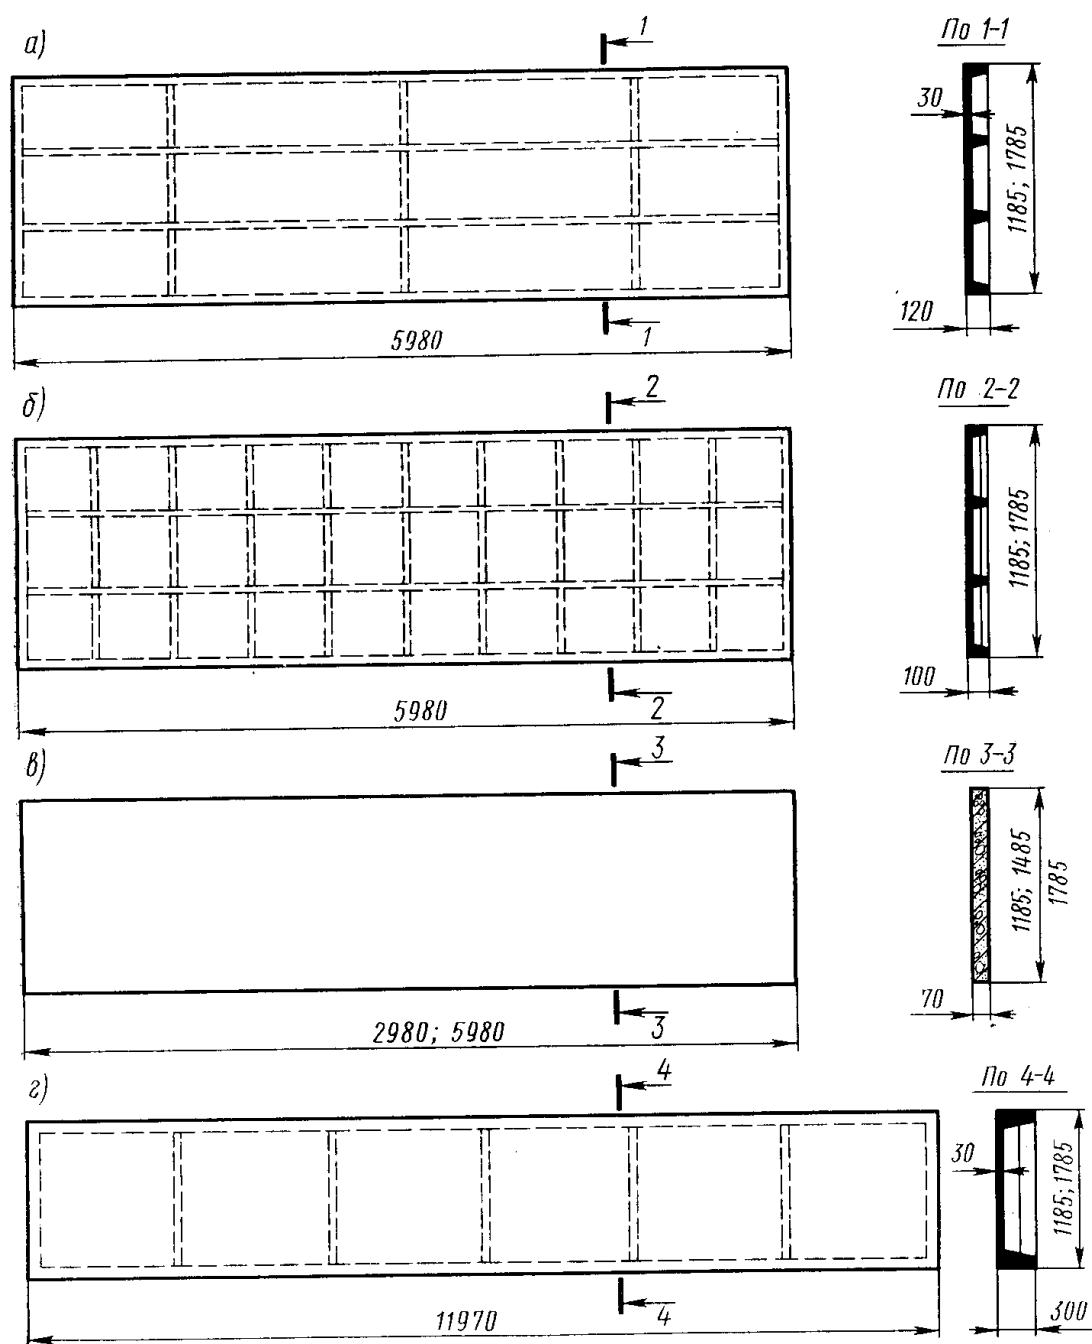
Схеми залізобетонних панелей для стін неопалюваних будівель:
